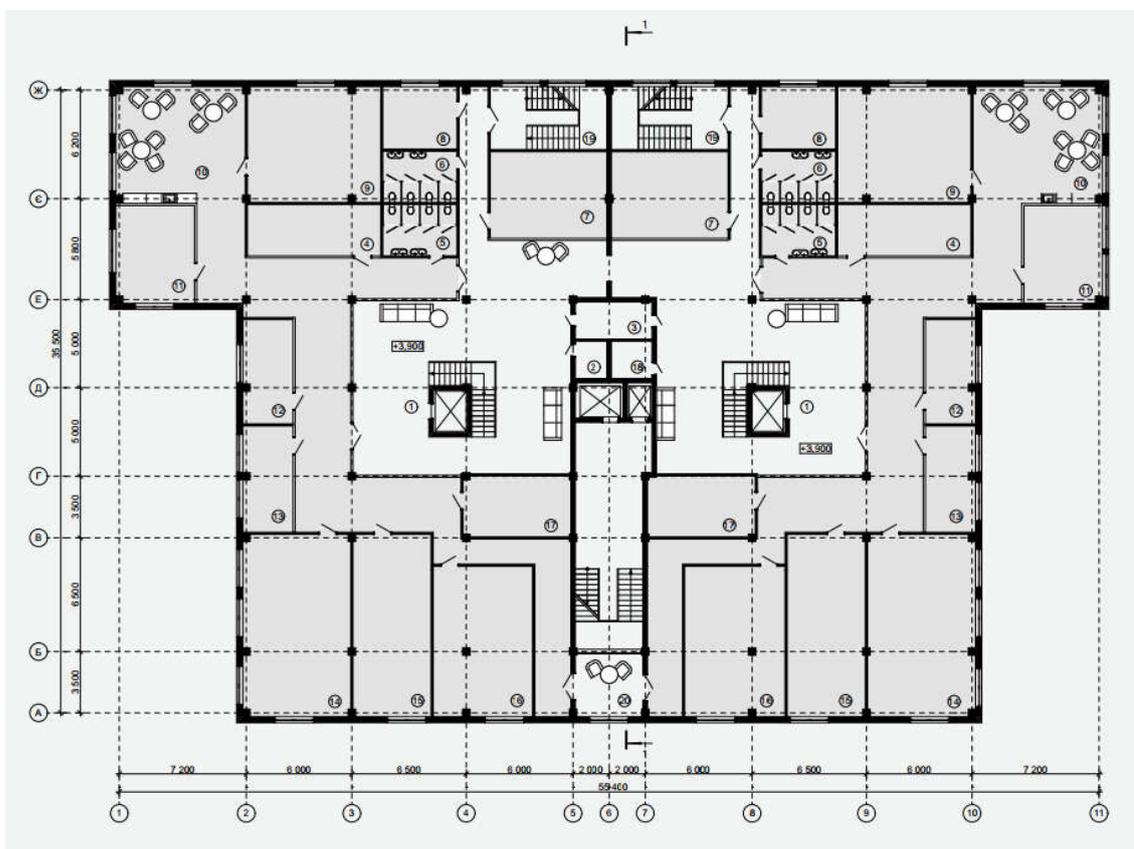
План другого поверху житлової будівлі з обслуговуванням
